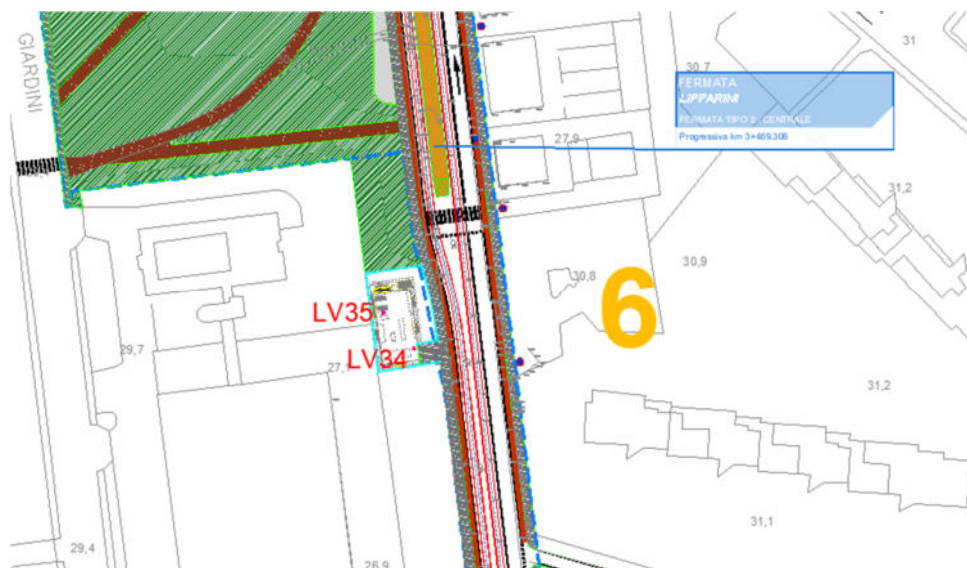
dettaglio planimetrico con la localizzazione dei sondaggi
